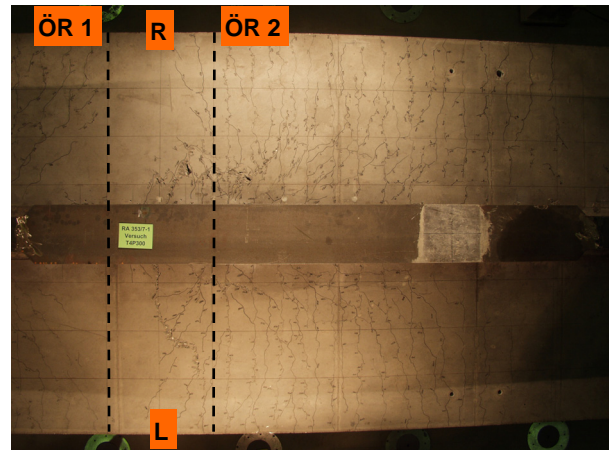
Rissbild auf der Betongurtunterseite
